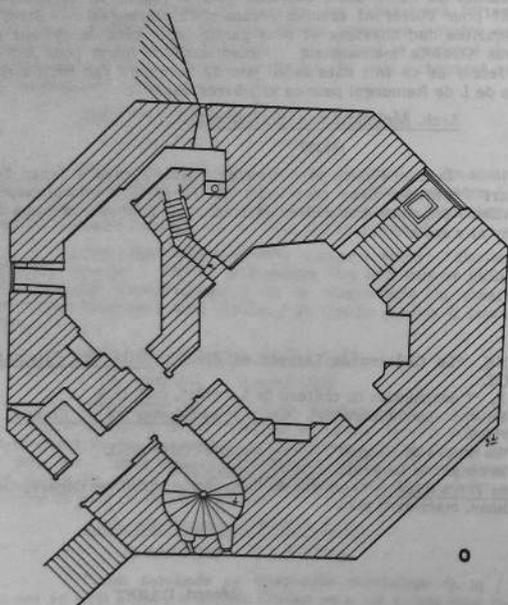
Elven. Donjon de Largoët. Plan au niveau du rez-de-chaussée.
